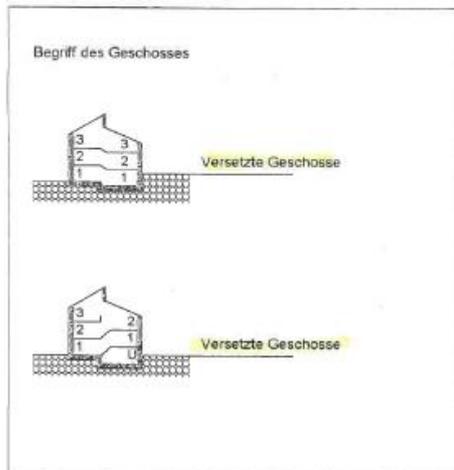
Berechnung der Vollgeschosse bei Split Level Bauten;
